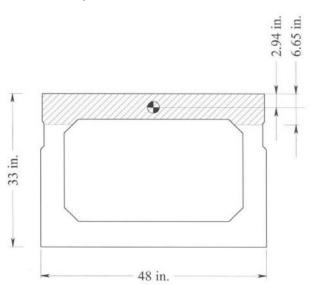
1—Sección transversal de viga en caja para determinar c
